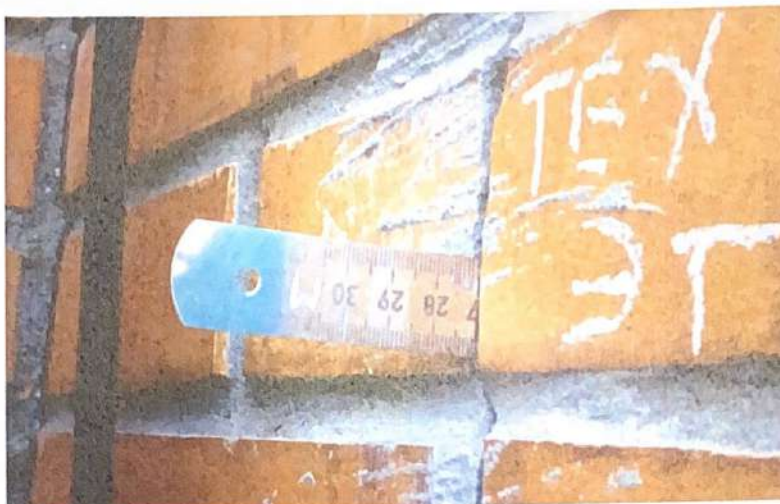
Секция 11. Фасад 2. Правый угол. Сквозная вертикальная трещина.
